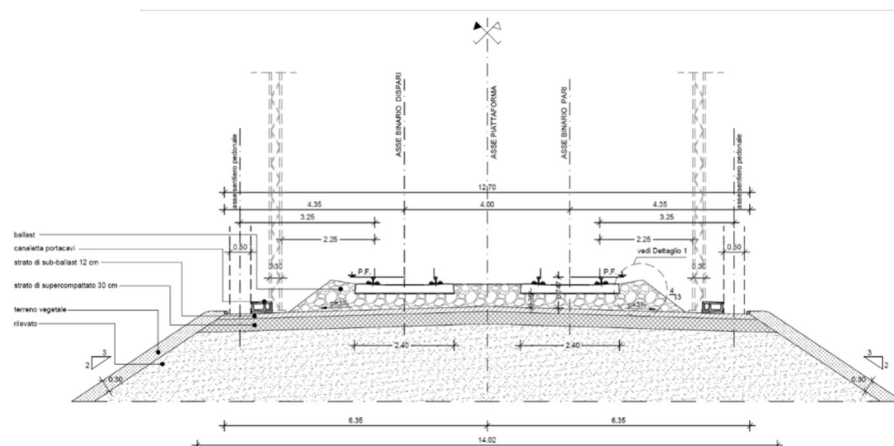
Sezione tipo ferroviaria in rilevato a doppio binario in rettilineo
